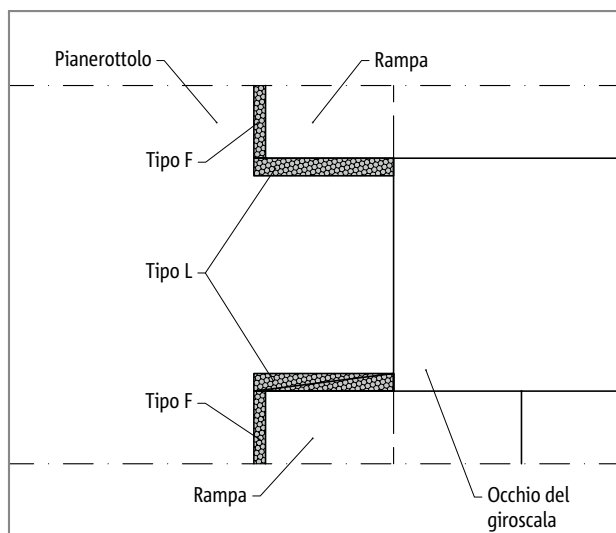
Schöck Tronsole® tipo F, disposizione dell'elemento; dettaglio A
